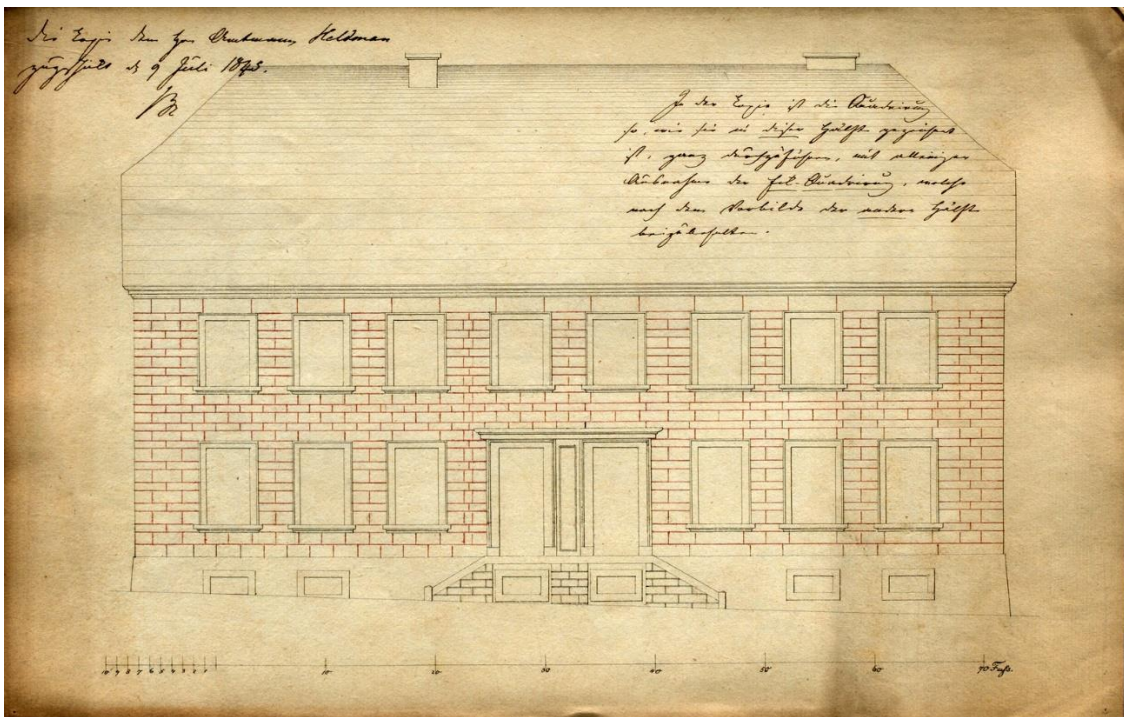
Fassadenaufriss mit Ausführungsplanung der Putzquaderung [Ferdinand Brune, 1837].
